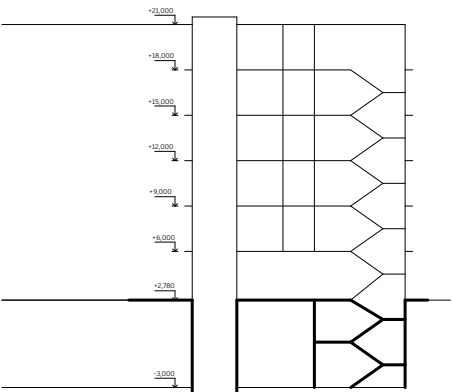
DETAIL ULOŽENÍ PREFA SCHODIŠTĚ 1:50
